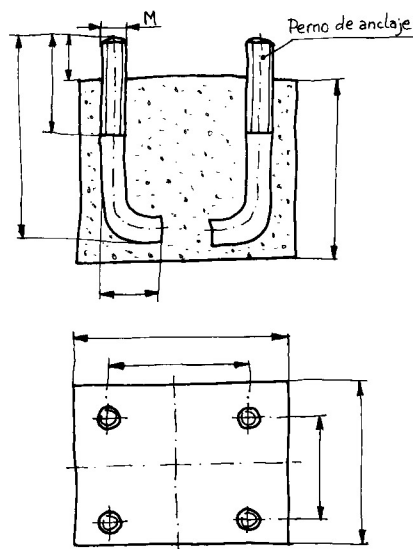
Cimentación de poste de señales con conducto para cableado
